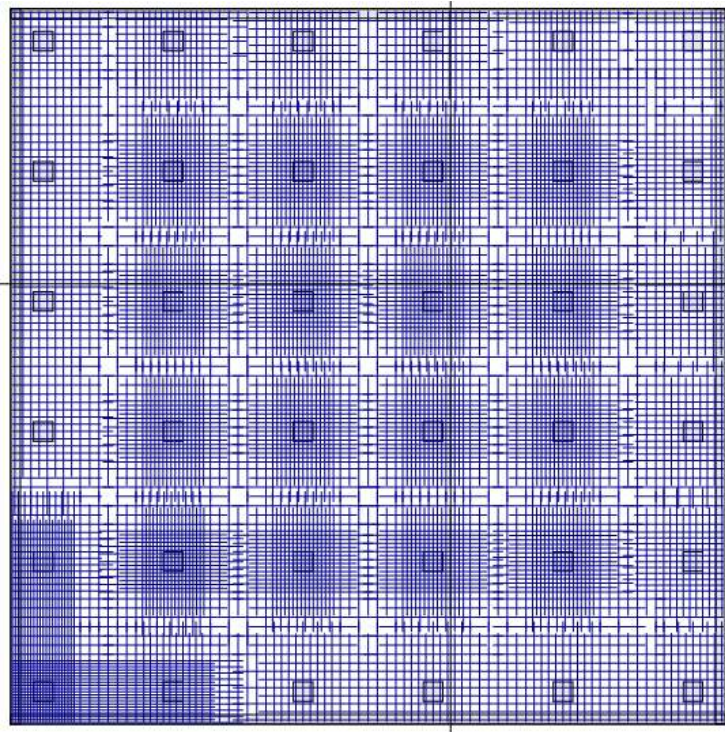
Esquema de armadura inferior de losa de cimentación.
